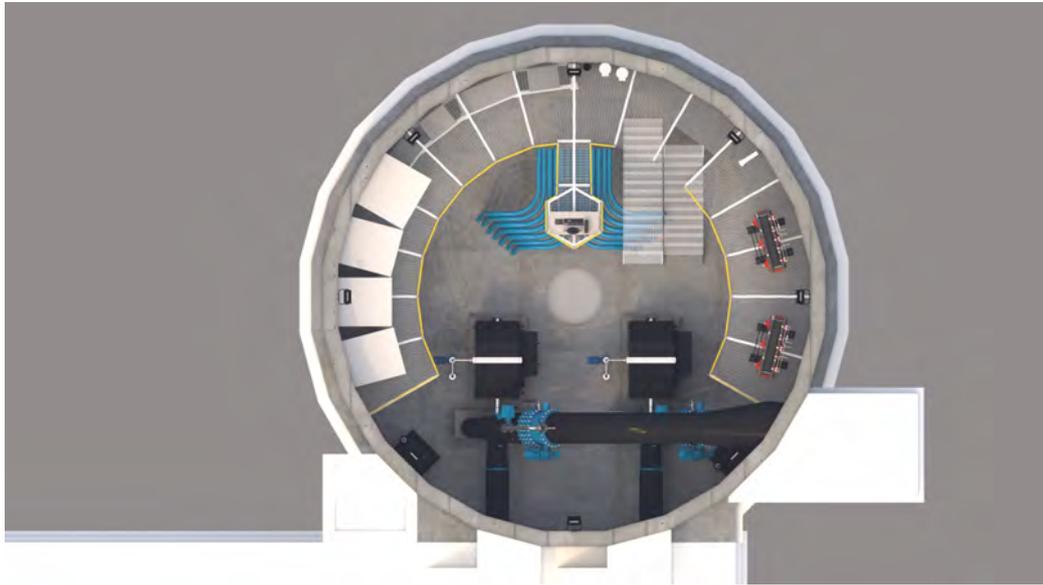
Vista in pianta del locale centrale in cui si osserva la forma circolare del locale.
